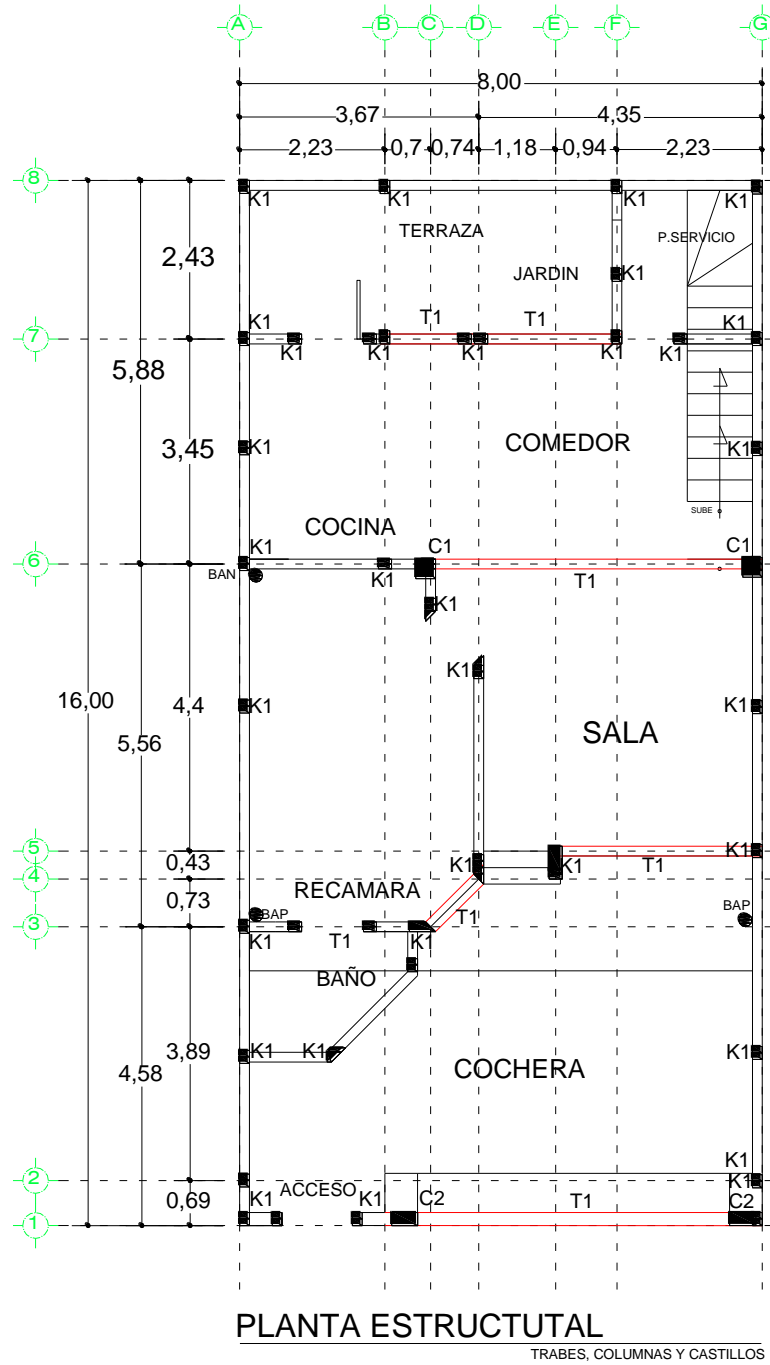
Planta baja estructural trabes, columnas y castillos.
